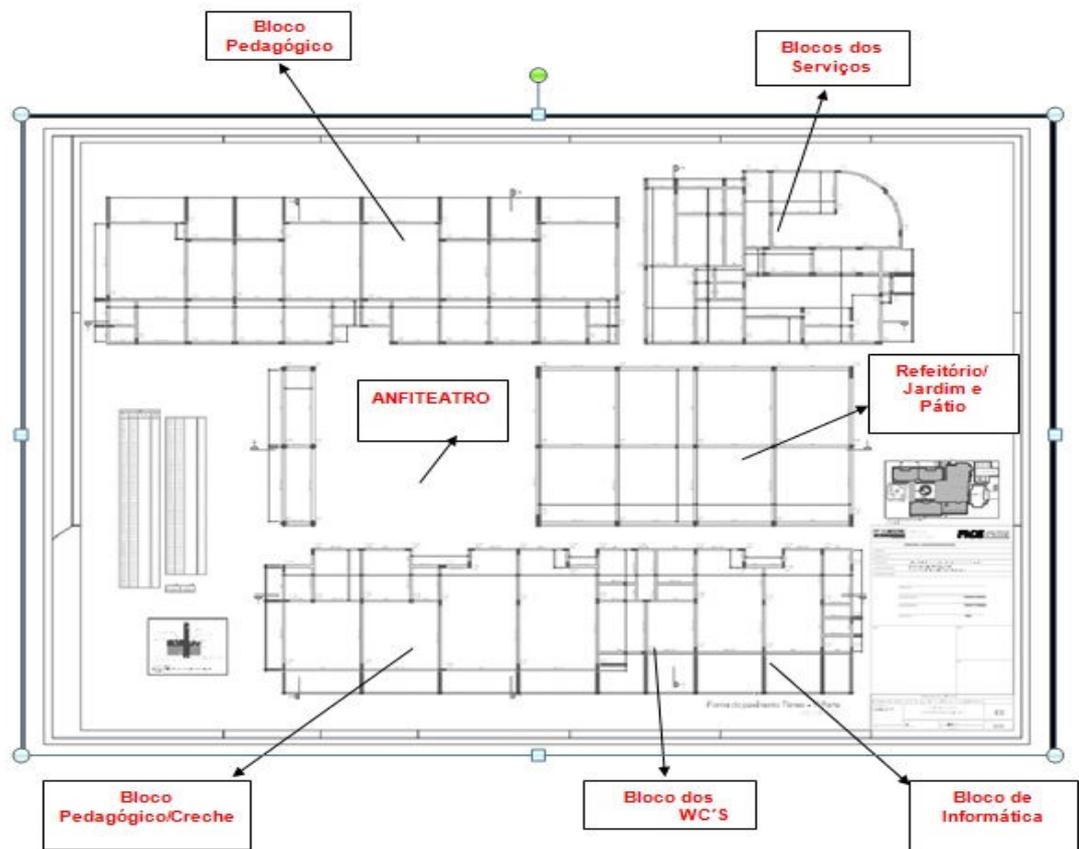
Vista da Planta Baixa da EMEI no Bairro 17 de março.
